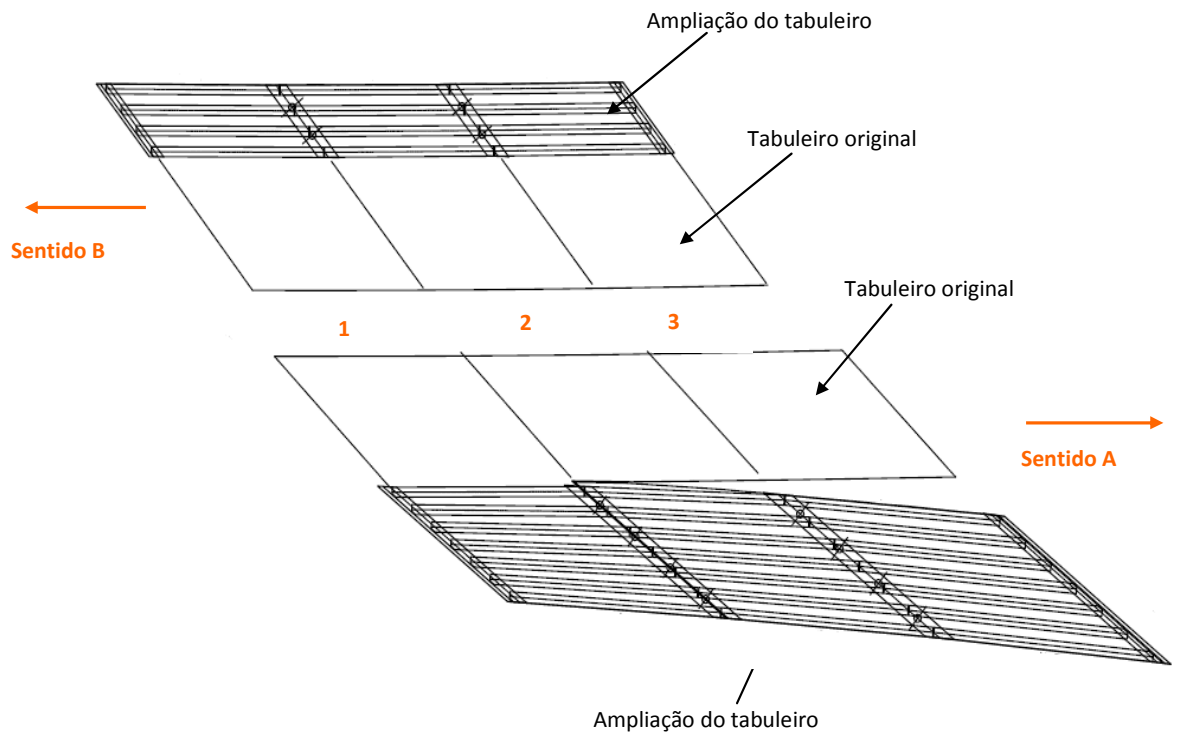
Vista em planta das passagens superiores situadas no p.k. 16 + 090
